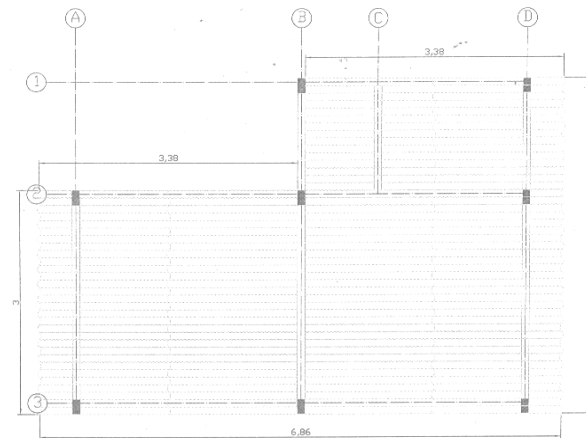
Planta de cubiertas proyecto VISR resguardo El Consejo
